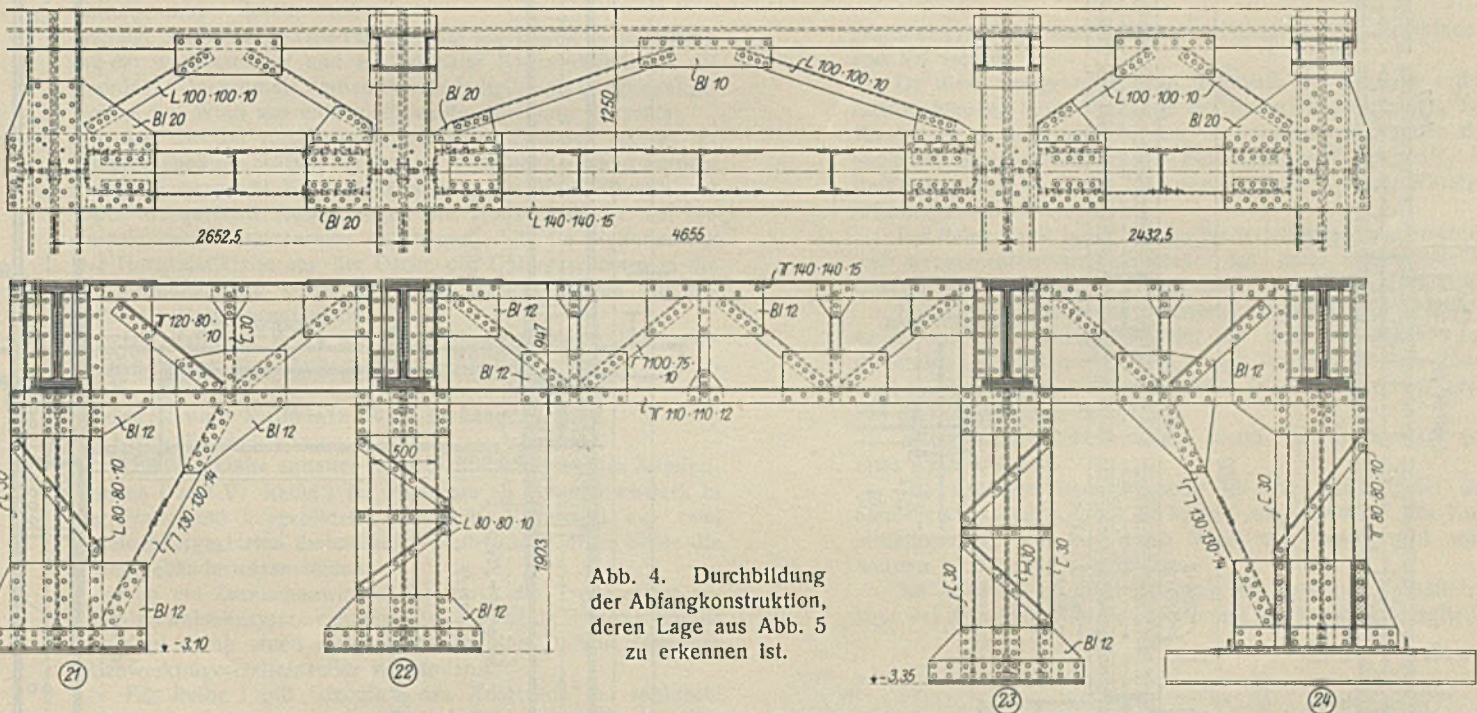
Durchbildung der Abfangkonstruktion, deren Lage aus Abb. 5 zu erkennen ist.
